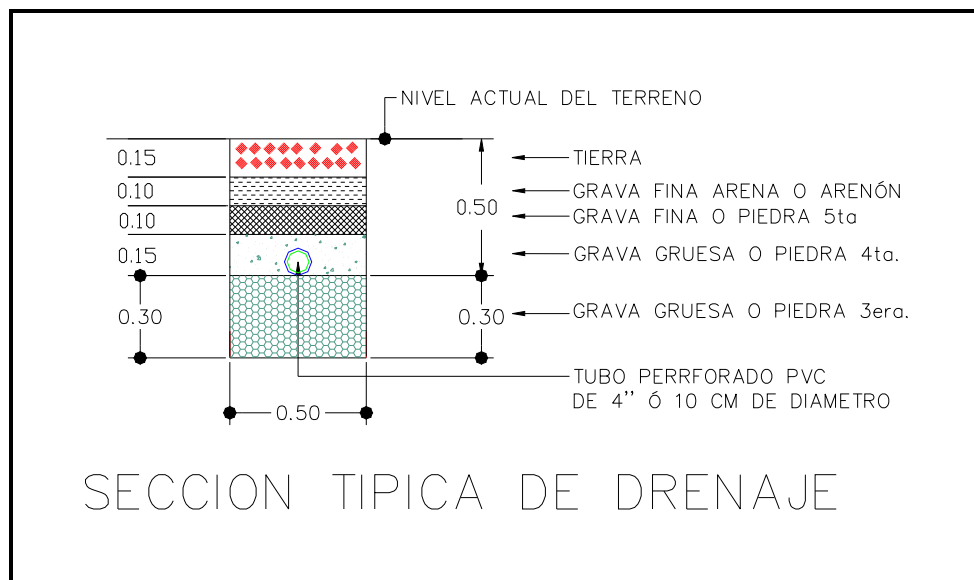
Detalle de sección típica de drenaje en vista lateral
